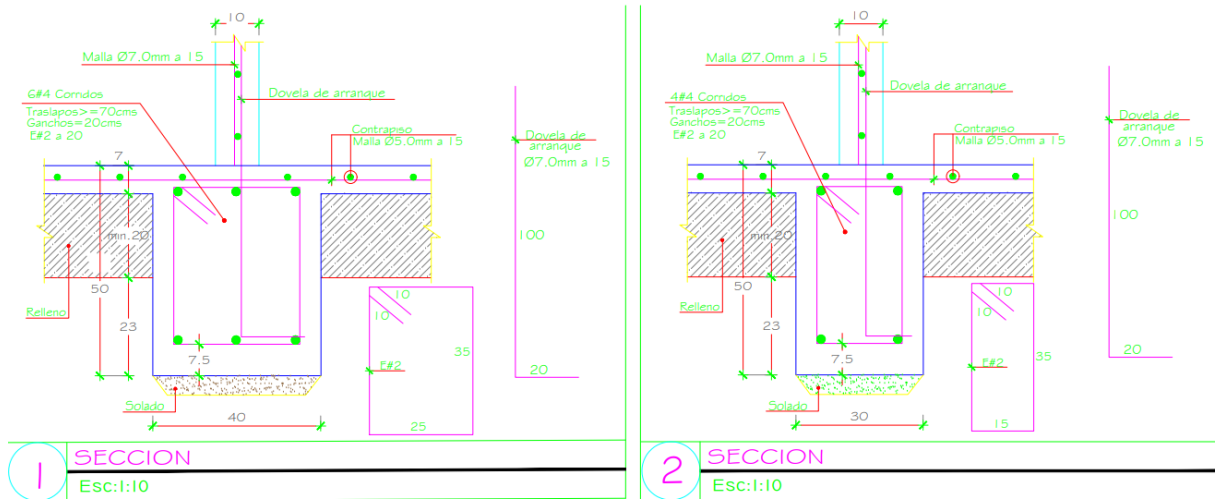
Cimentación pacha 2 casas Proyecto Bosque Encantado.
